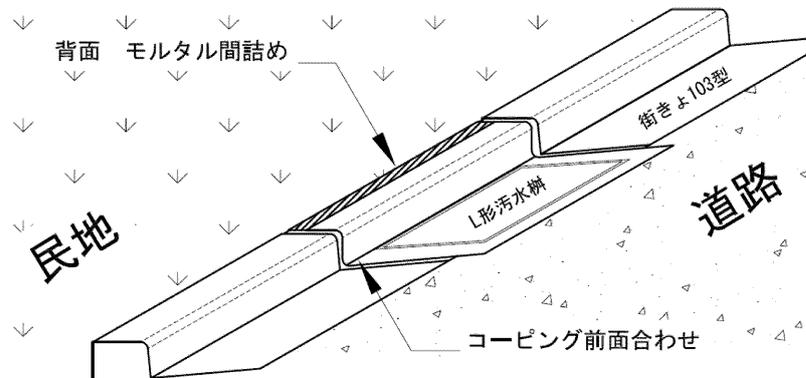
街きよ 103 型整備路線の公共樹 (L 形柵縁塊) 配置図
